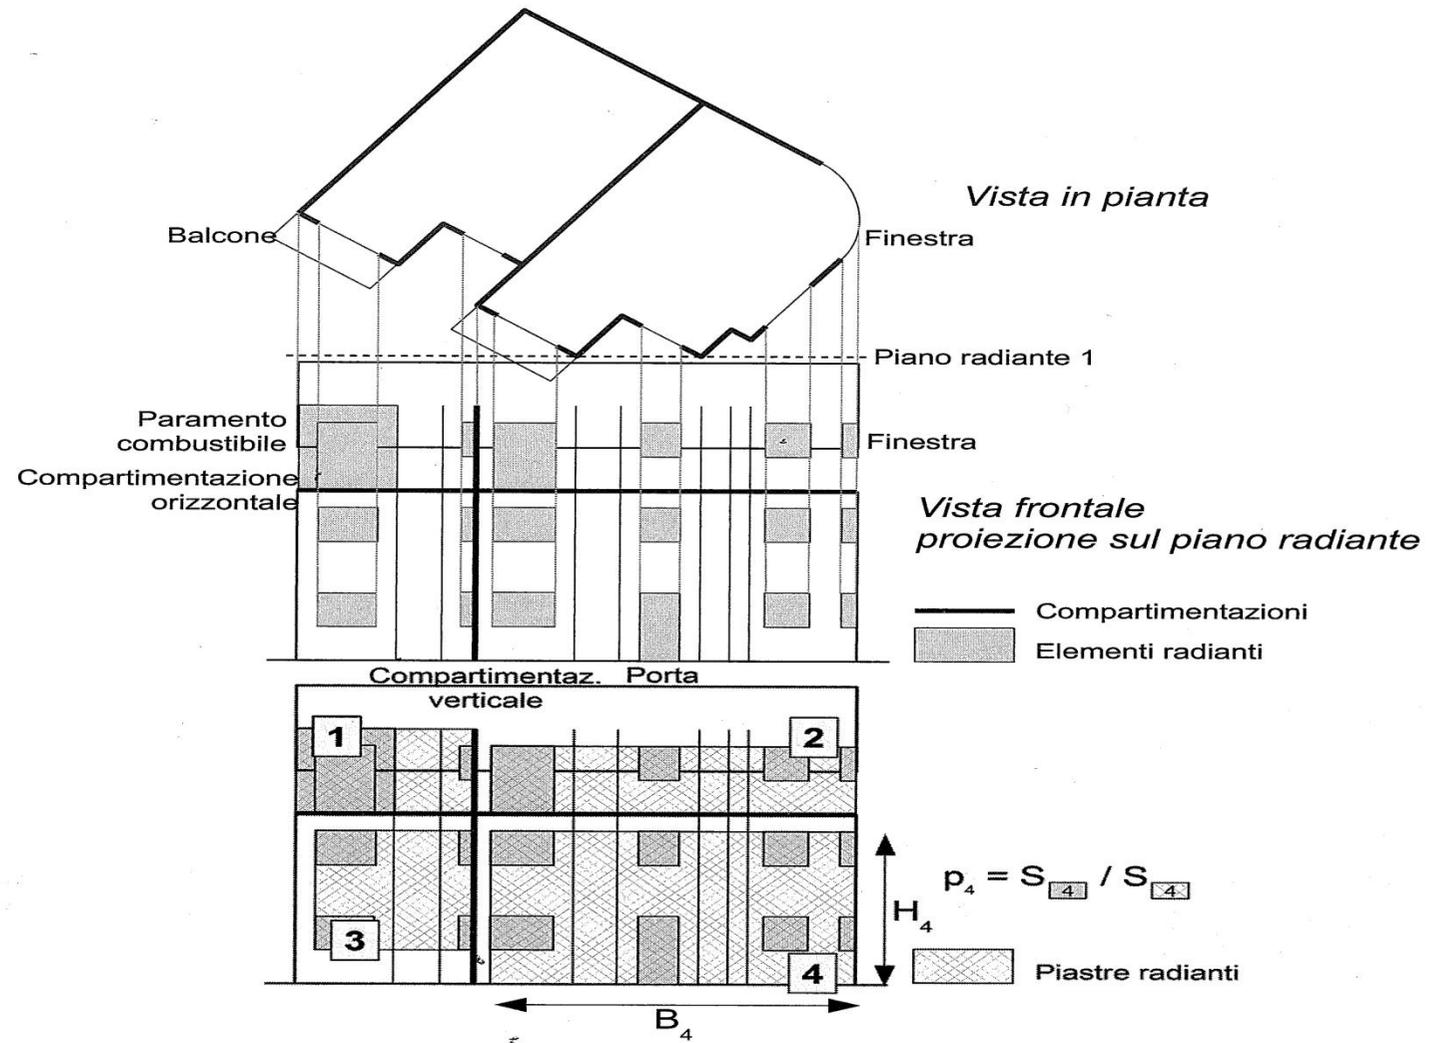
Determinazione delle piastre radianti, vista in pianta e frontale
